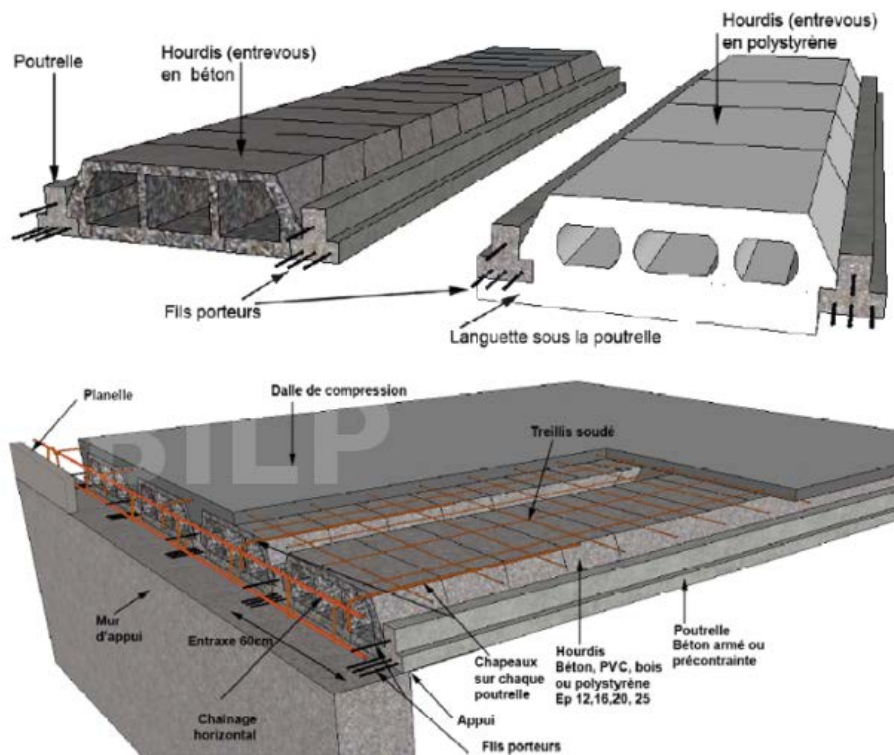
22 : Le plancher semi préfabriqué (poutrelle en béton –hourdis en polystyrène - dalle de compression)
